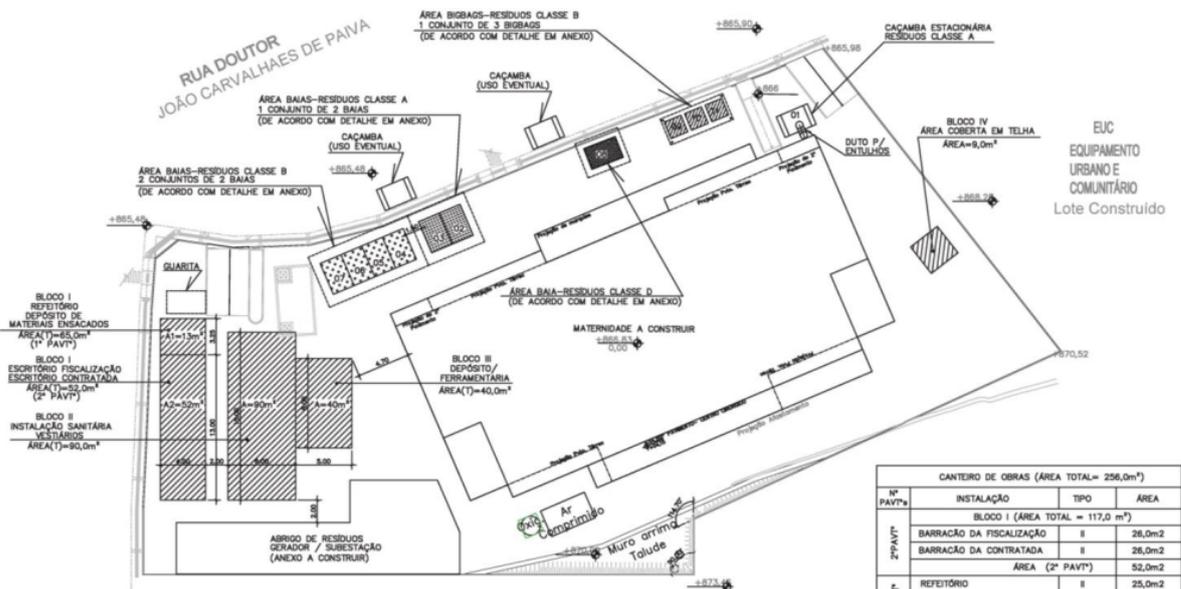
Planta ilustrativa de canteiro da obra. Fonte: Arquivo SUDECAP (2019).
